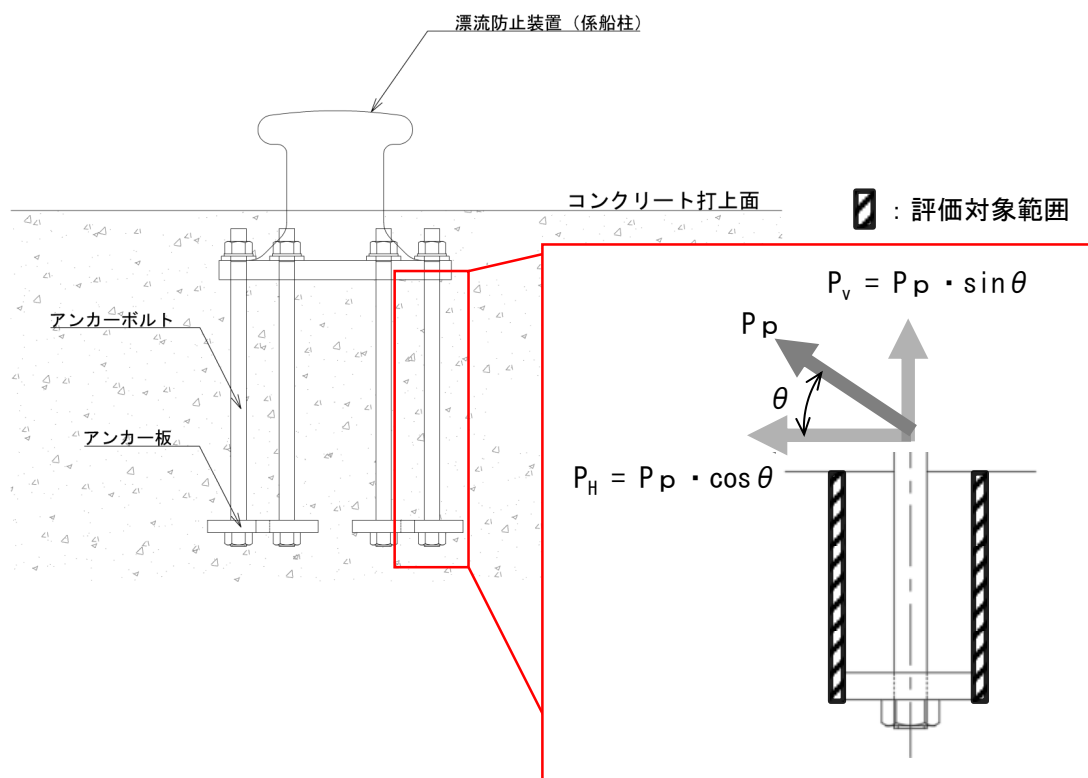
コンクリート（アンカーボルト側面）のモデル図
